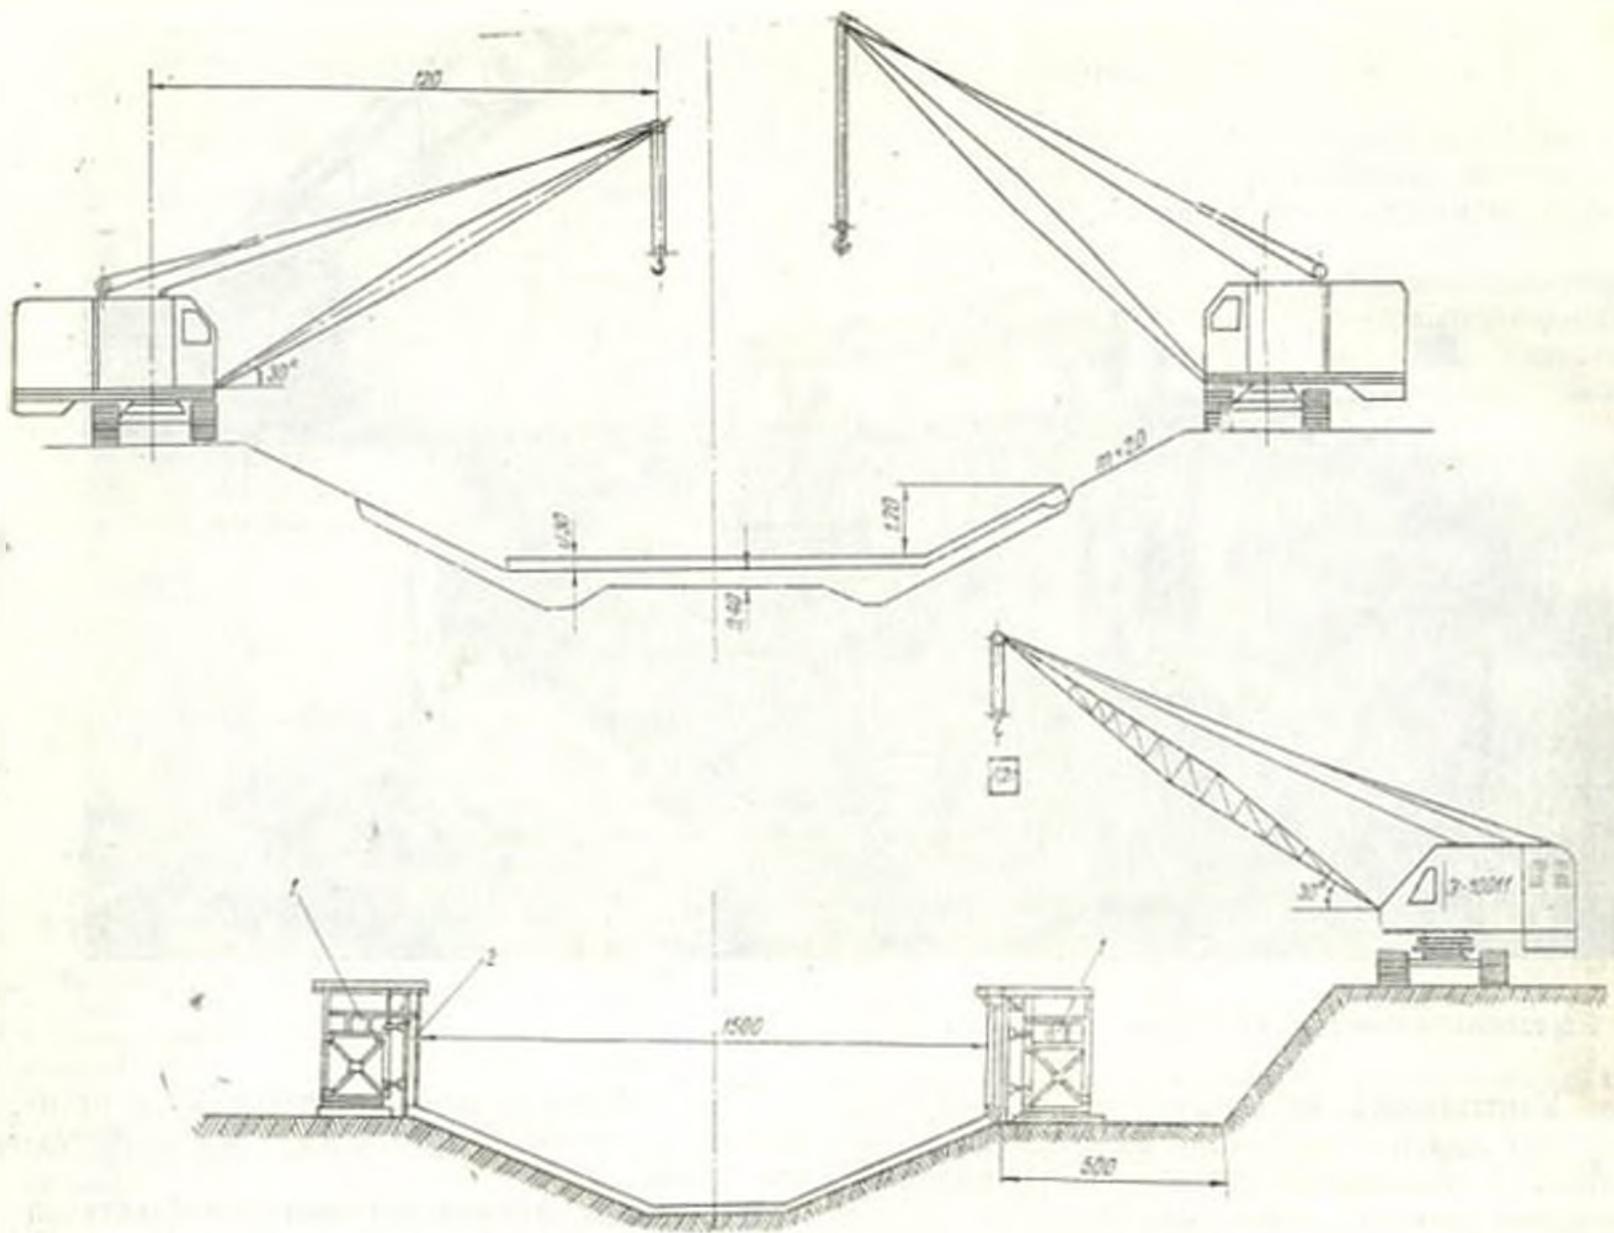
Схема укладки экскаватором-краном Э-10011 бетона с ГК 66+00 до ГК 200+00 в катучую опалубку (1) стенок БАК (2 — вторая очередь бетонирования).
